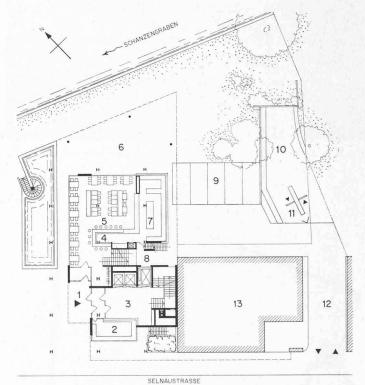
Rez-de-chaussée. Echelle 1:500. 1. Entrée principale. – 2. Kiosque. – 3. Hall. – 4. Bar. – 5. Restaurant. – 6. Terrasse. – 7. Cuisine. – 8. Service. – 9. Parking. – 10. Rampe d'accès aux garages. – 11. Contrôle. – 12. Passage. – 13. Immeuble Selnaustr. 12.
